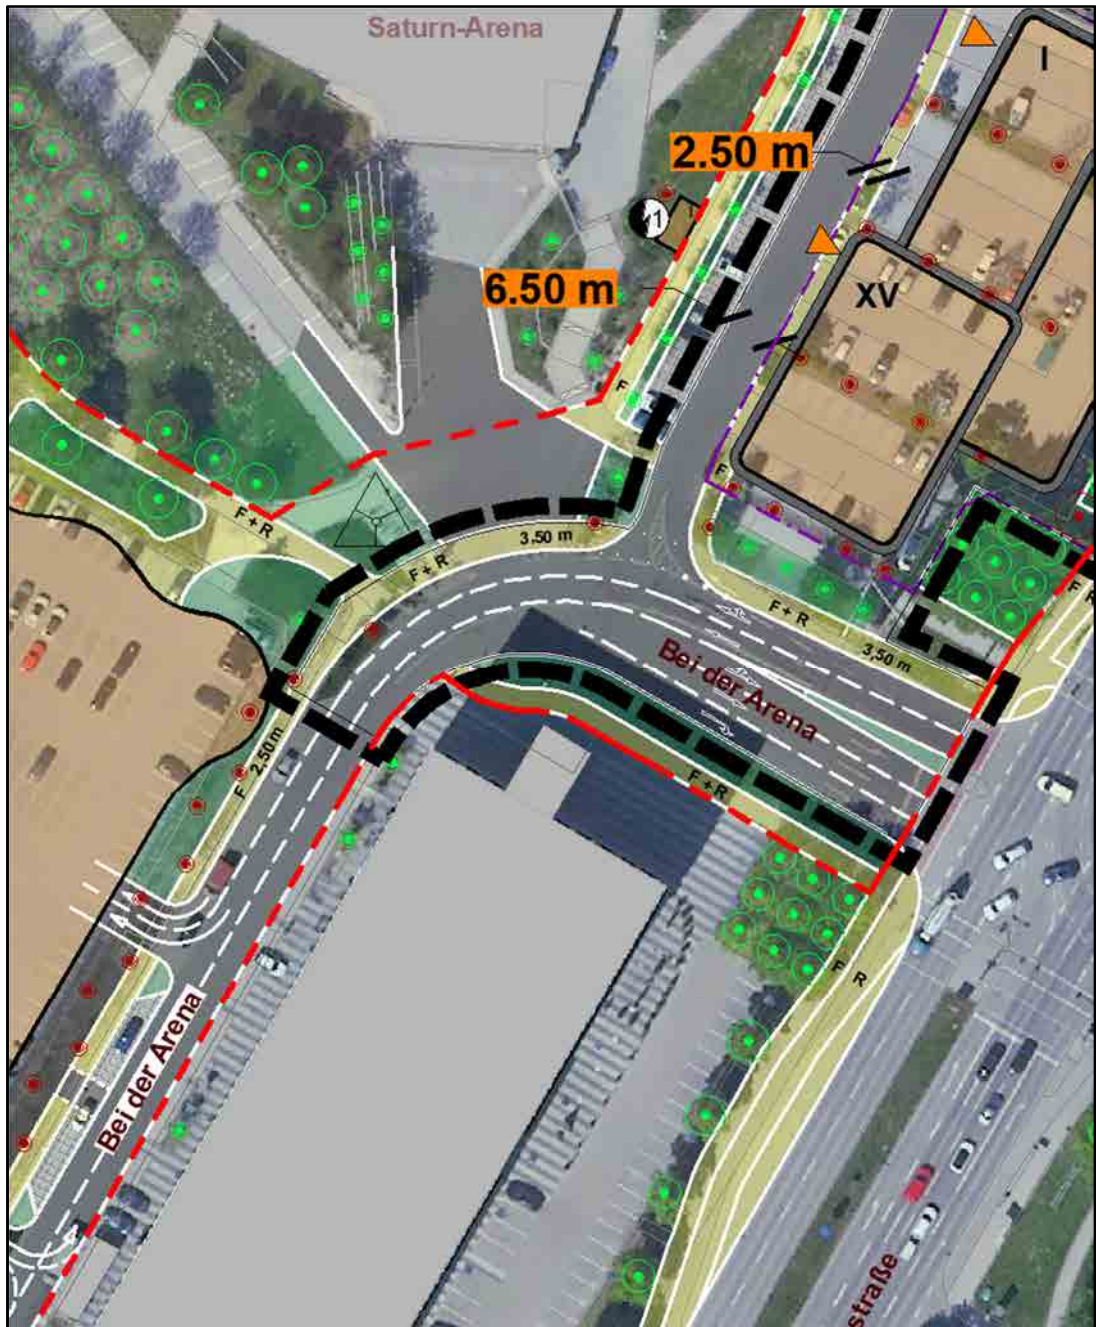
Rahmenplan mit Luftbild hinterlegt, Ausschnitt Verschwenkung Straße Bei der Arena
